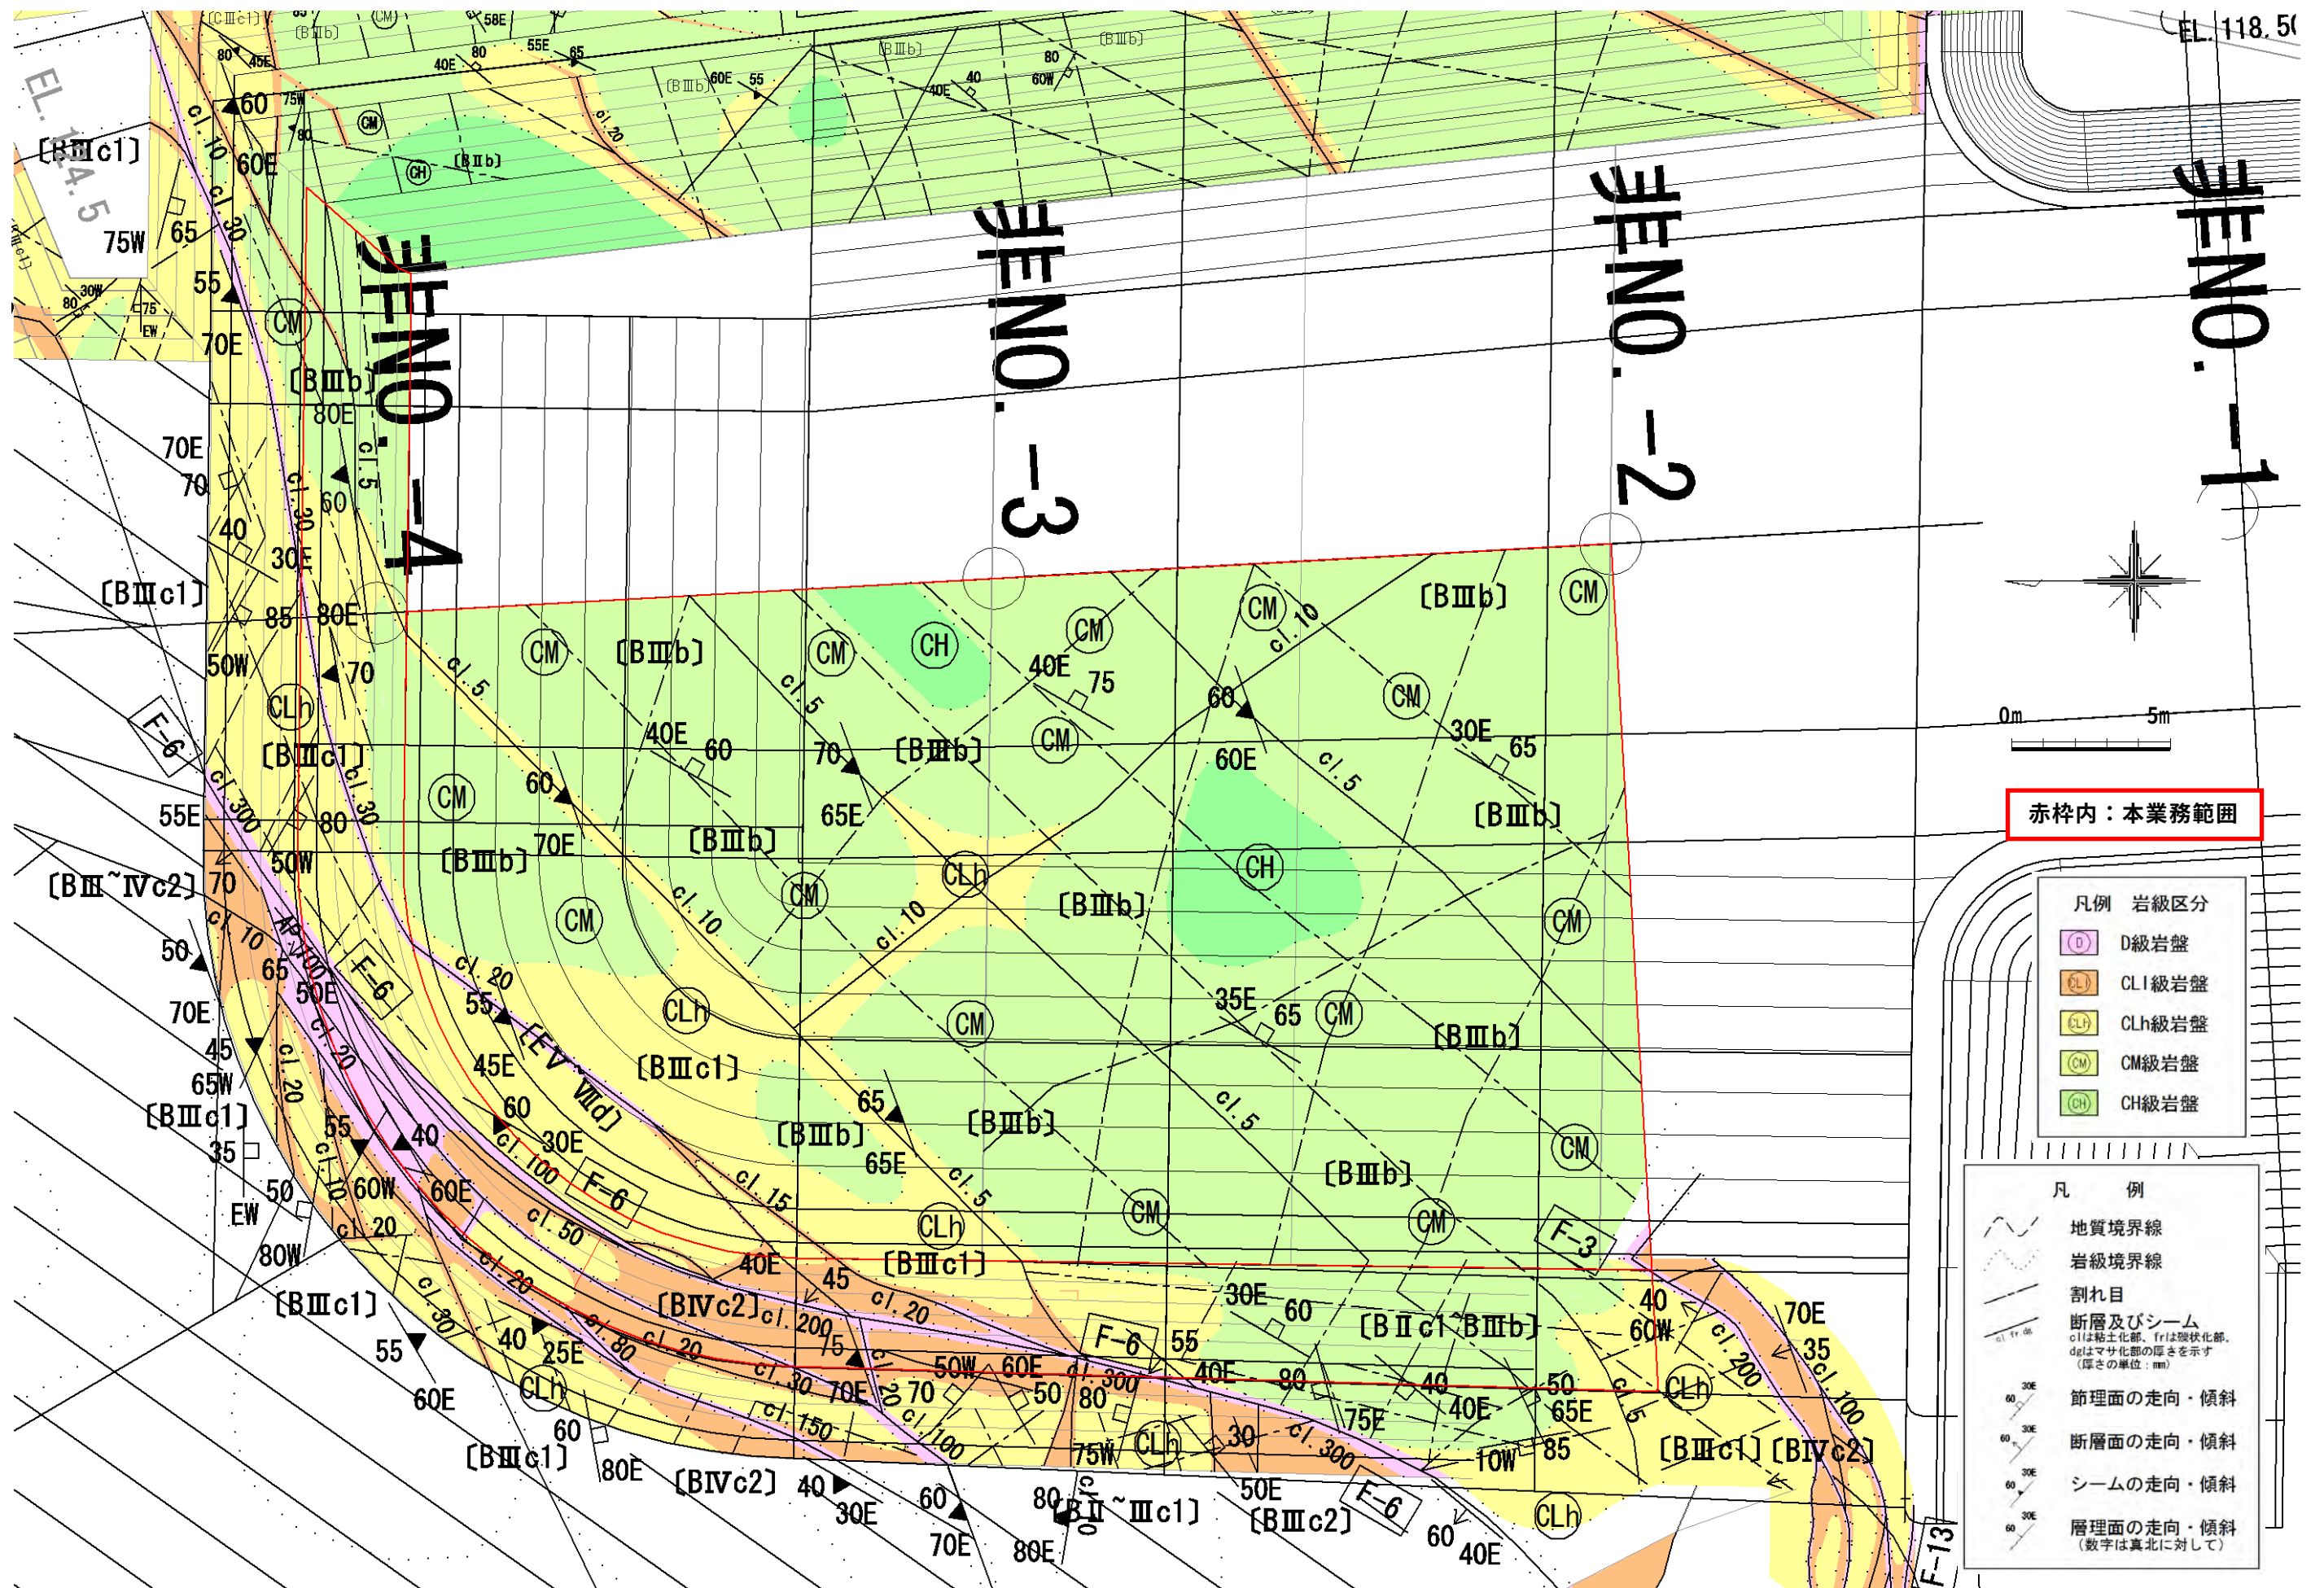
岩盤スケッチ平面図 (岩級区分)
